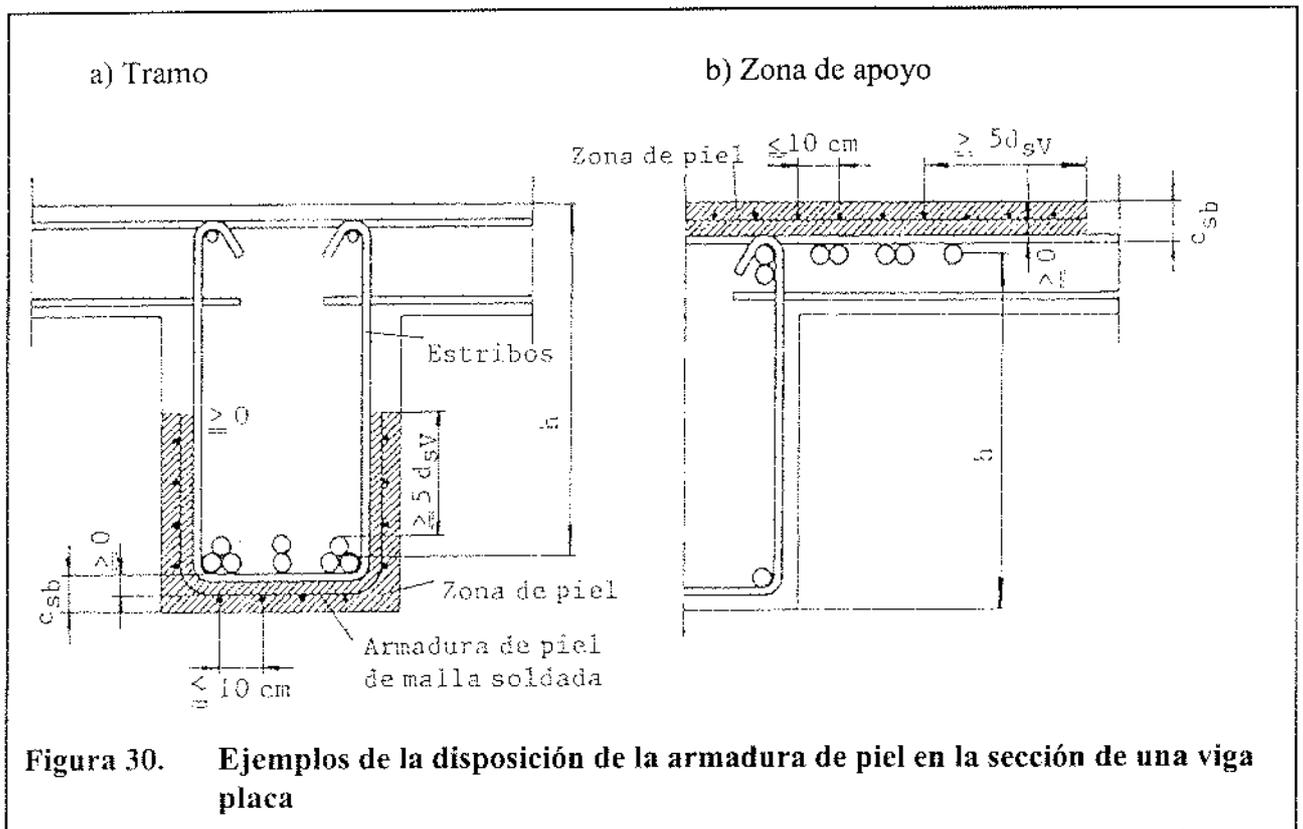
Ejemplos de la disposición de la armadura de piel en la sección de una viga placa
